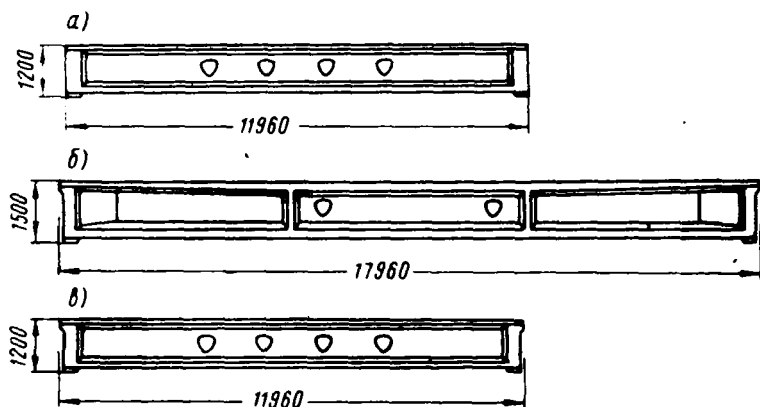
Типовые предварительно напряженные балки для зданий с плоской кровлей
